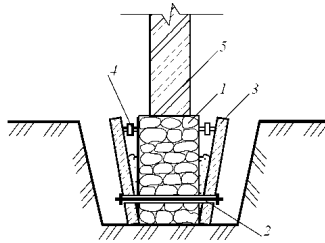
Увеличение подошвы фундамента с помощью железобетонных отливов: 1 – фундамент, 2 – стальной тяз, 3 – железобетонный отлив, 4 – домкрат, 5 – стена
